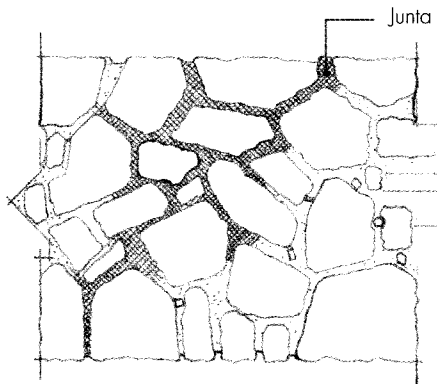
Piedra natural sin labrar, con junta de mortero.
